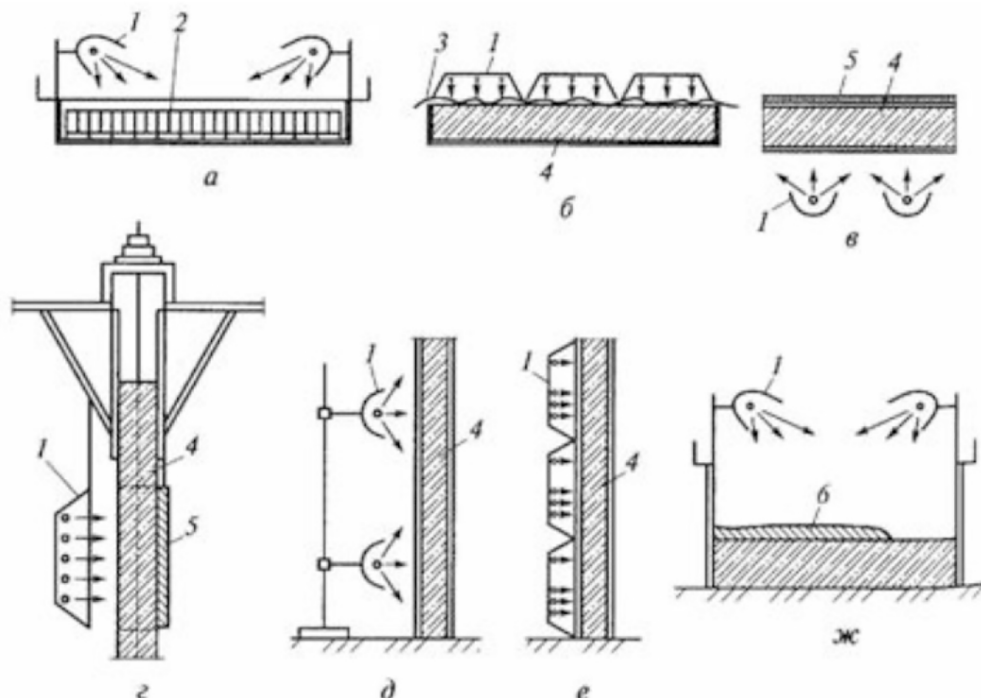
Схемы инфракрасного нагрева: а – обогрев арматуры плиты; б, в – термообработка бетона плиты (сверху и снизу); г – локальная термообработка бетона при возведении высотных сооружений в скользящей опалубке; д, е – термообработка бетона стен; ж – тепловая защита укладываемой бетонной смеси; 1 – инфракрасная установка; 2 – арматура плиты; 3 – синтетическая пленка; 4 – термообрабатываемый бетон; 5 – теплоизолирующий мат; 6 – укладываемая бетонная смесь [7]
